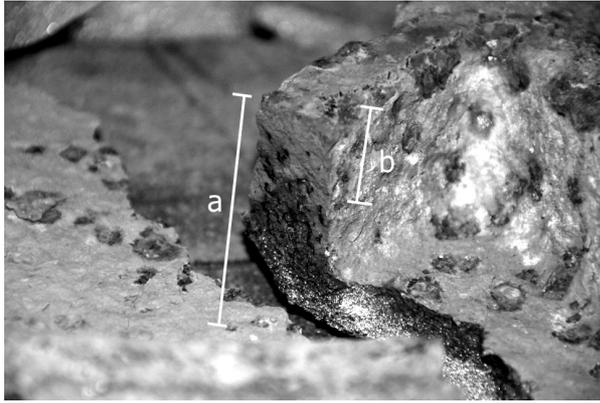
Profundidade da fissura em T2 (a - altura total do cutelo; b - profundidade da fissura)
